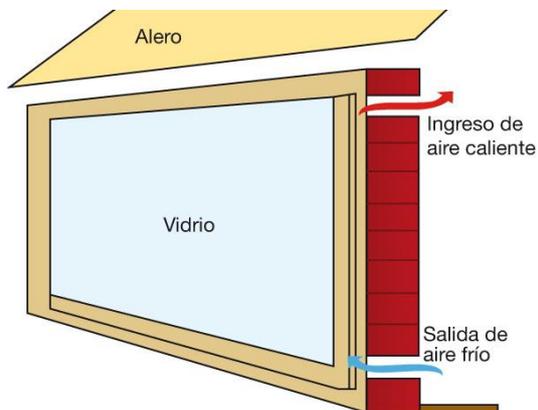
Esquema del muro Trombe. Fuente: web 22
